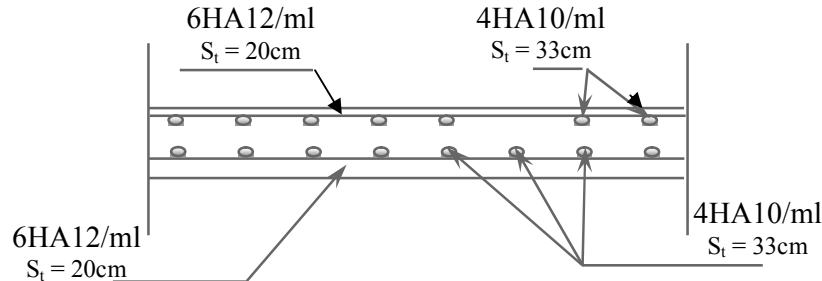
Schéma de ferrailage de la dalle de balcon (D7) sur deux appuis.
